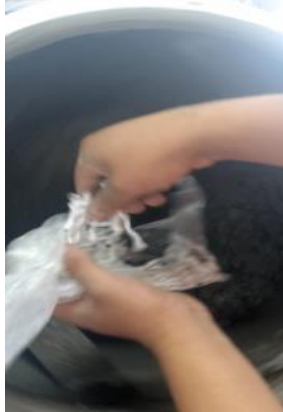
Elaboración de especímenes de concreto con adición de fibras de Nylon.
